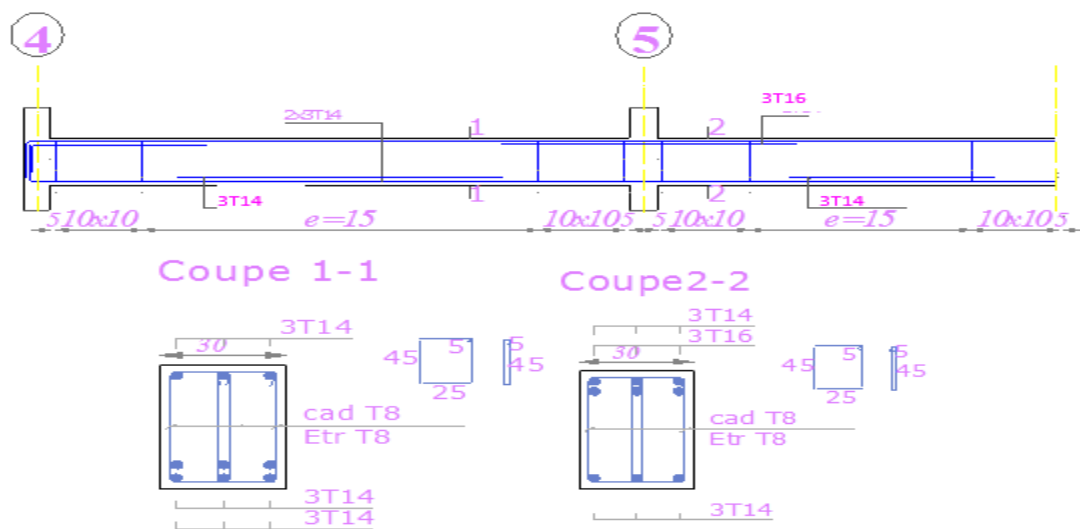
Schéma de ferrailage d'une poutre principale –la plus sollicitée–
